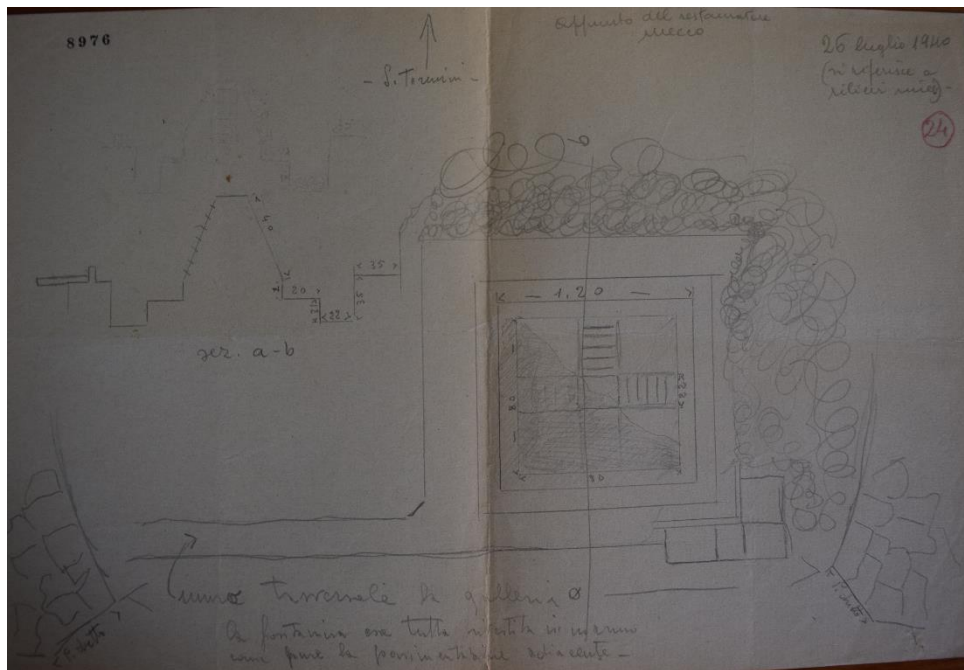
Planimetria della fontana della cd. Casa del Pothos (ACS, ARchivio Gatti, Metropolitana, c. 8976)
